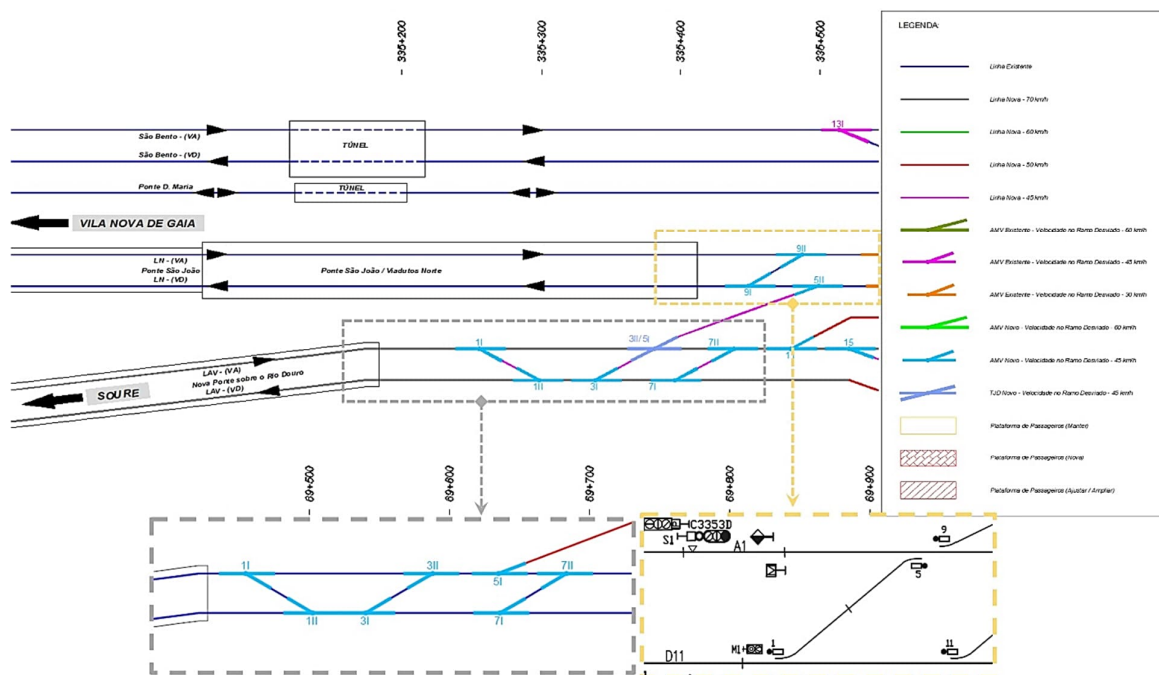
Encontro Norte da futura Ponte sobre o Douro – Análise Armamento de via
